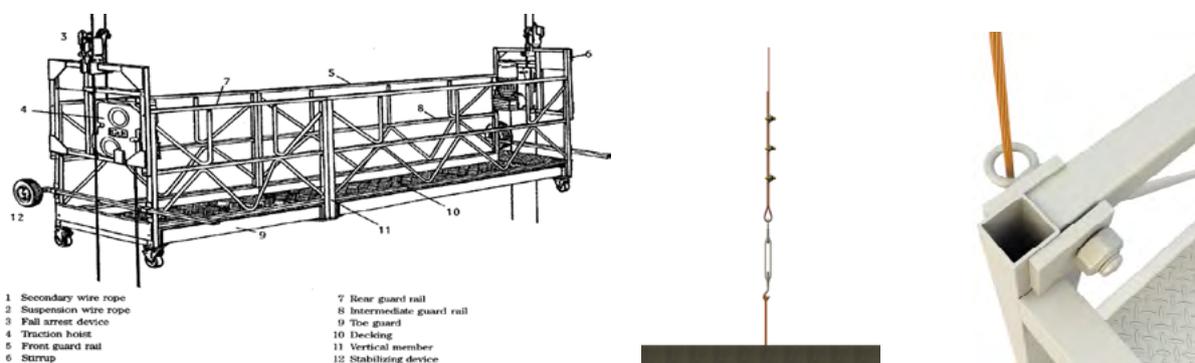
(a) Sistema de estabilización compuesto por ruedas que separan el andamio de la superficie de fachada; (b) Sistema de estabilización compuesto por cable de acero tensado
